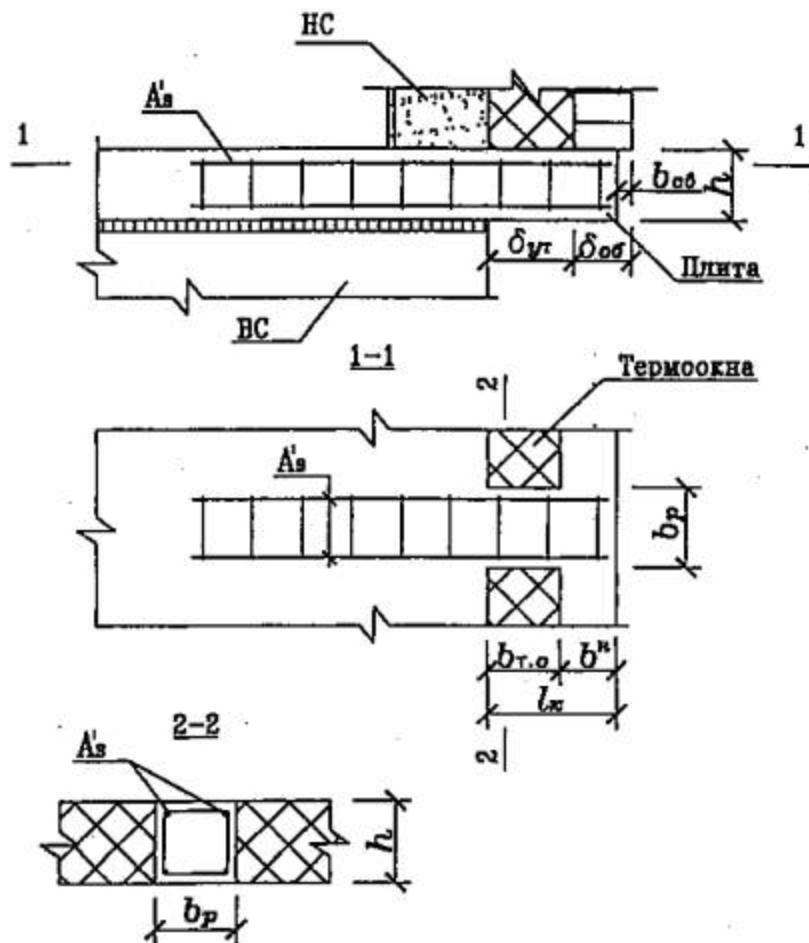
Схемы армирования ребер между «термоокнами» (арматура плиты условно не показана)
